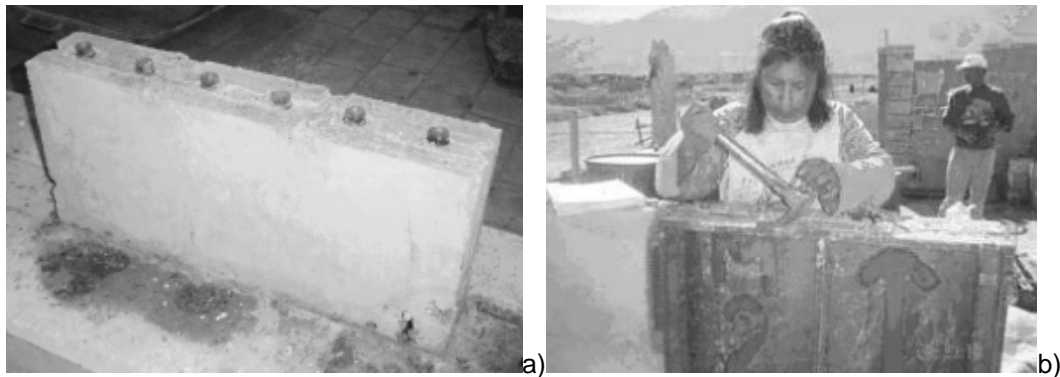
a) Bloque de concreto aligerado con envases de pet y b)Mujer participante en el proyecto durante la construcción de un muro para su vivienda.
